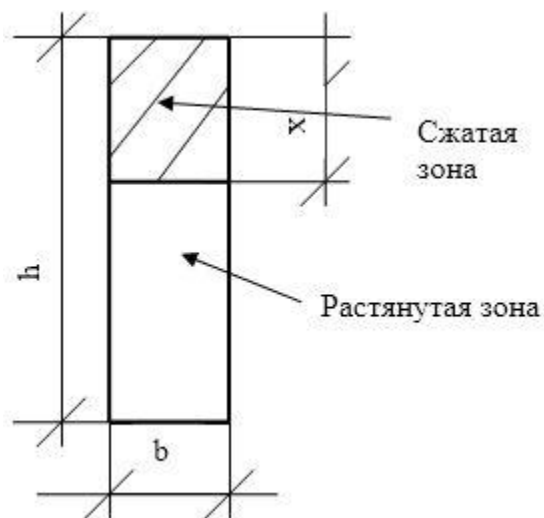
Схема расположения сжатой и растянутой зоны в железобетонной балке tensile.
